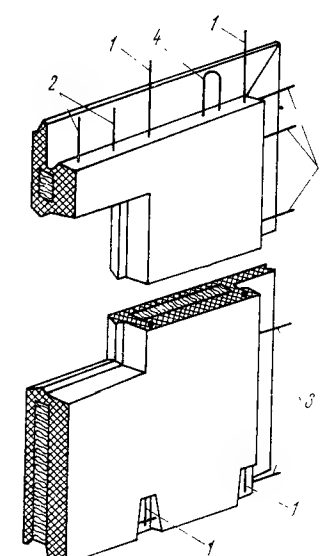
Panou prefabricat pentru peretele exterior:
